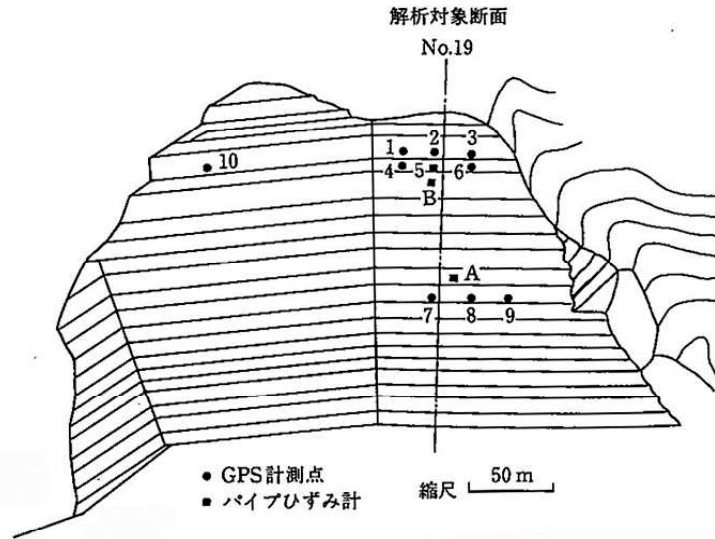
大断面斜面掘削の事例 現場平面図、GPS計測およびパイプひずみ計位置図
